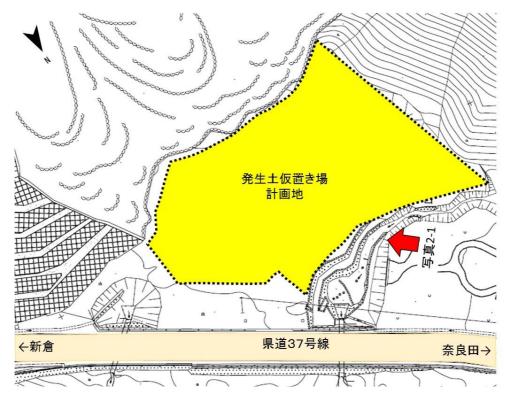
湯島地区発生土仮置き場計画地平面図 (現況)
